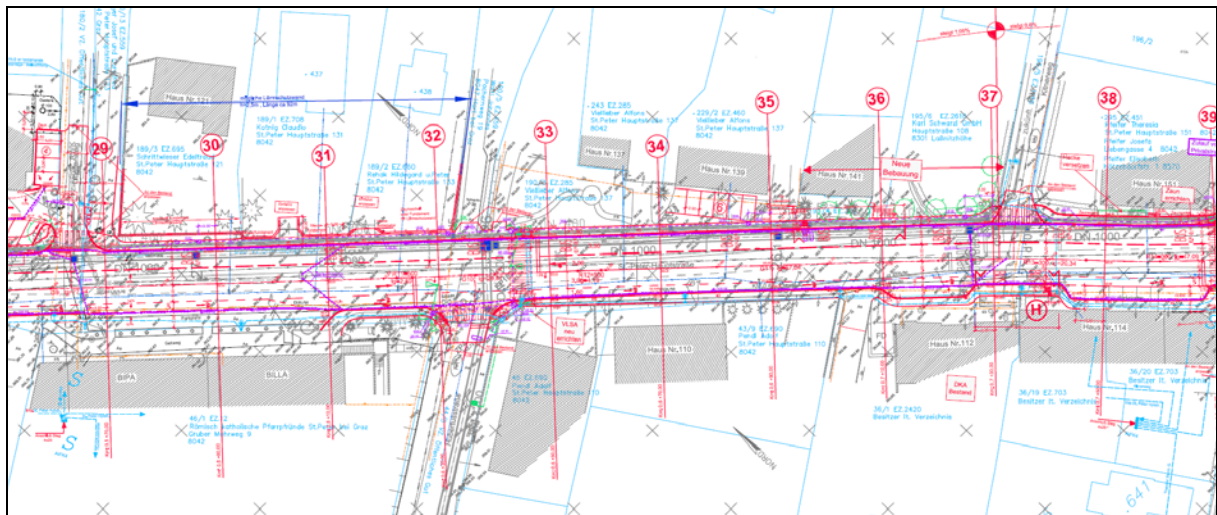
Planausschnitt Lageplan Ausbau St.-Peter-Hauptstraße
